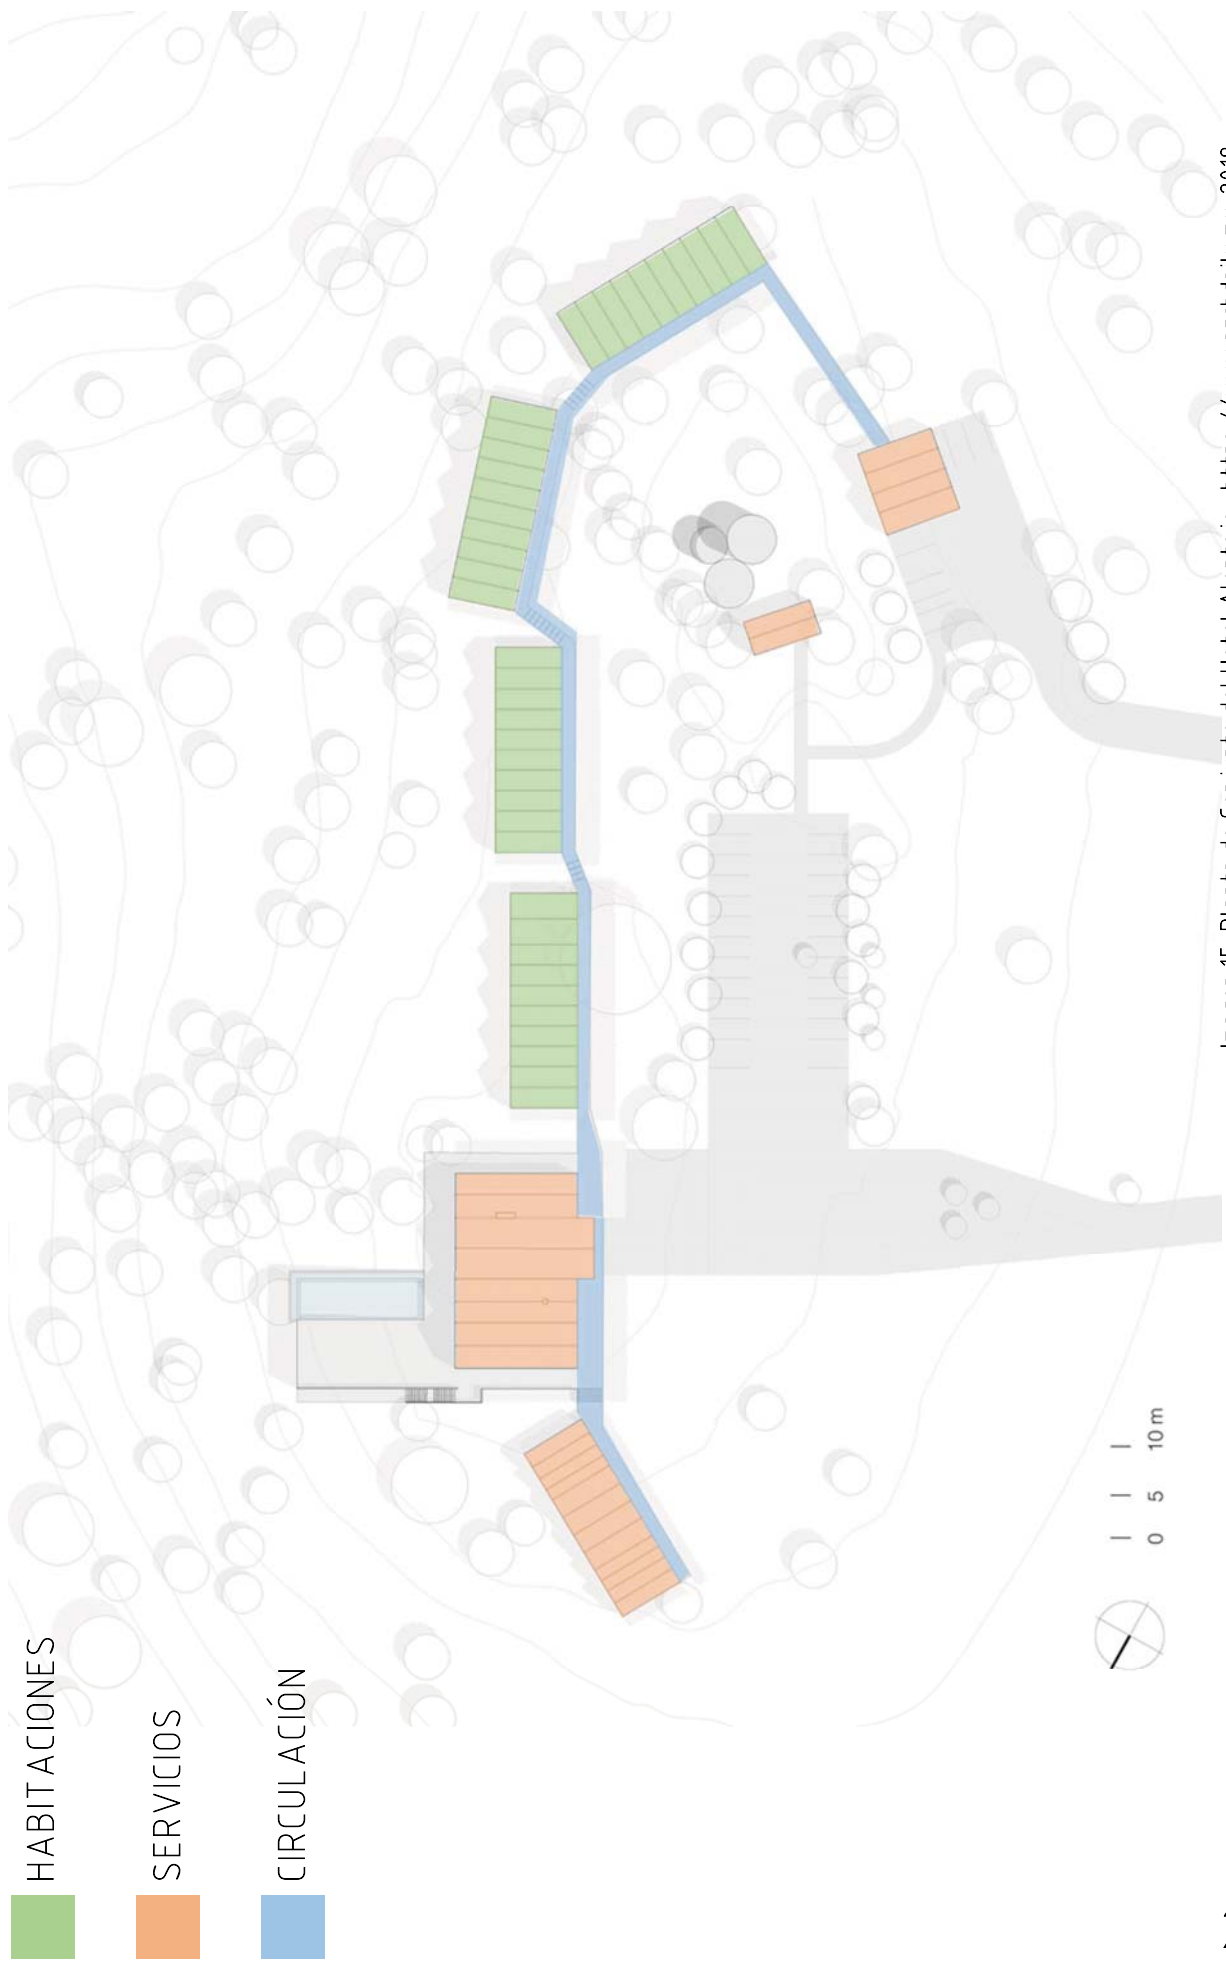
Planta de Conjunto del Hotel Alentejo . <https://www.archdaily.mx>. 2018
